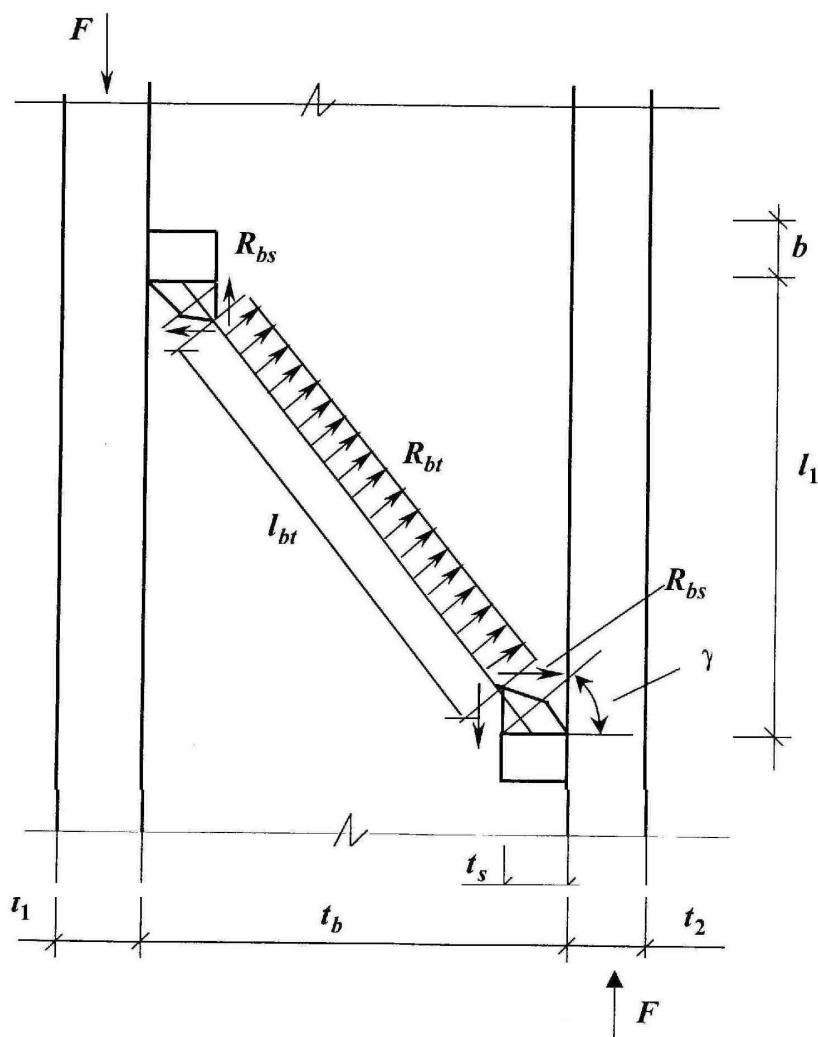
Расчетная схема бетонного заполнения на раскалывание в соответствии с работой [7].
